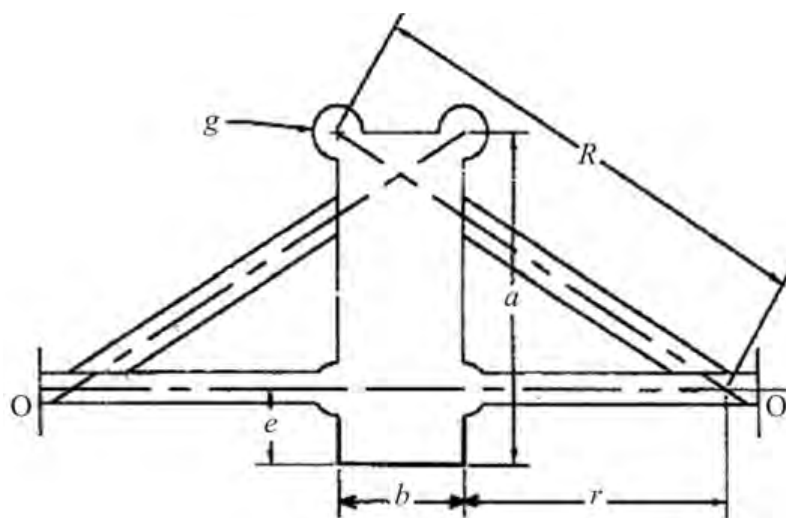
Шаблон для определения ширины проезда: a — длина автомобиля; b — ширина автомобиля; e — задний свес; R — внешний габаритный радиус; g — рекомендуемое приближение автомобиля к конструкциям здания (оборудованию) при въезде; r — внутренний габаритный радиус (определяется в процессе построения шаблона); O — ось вращения шаблона
